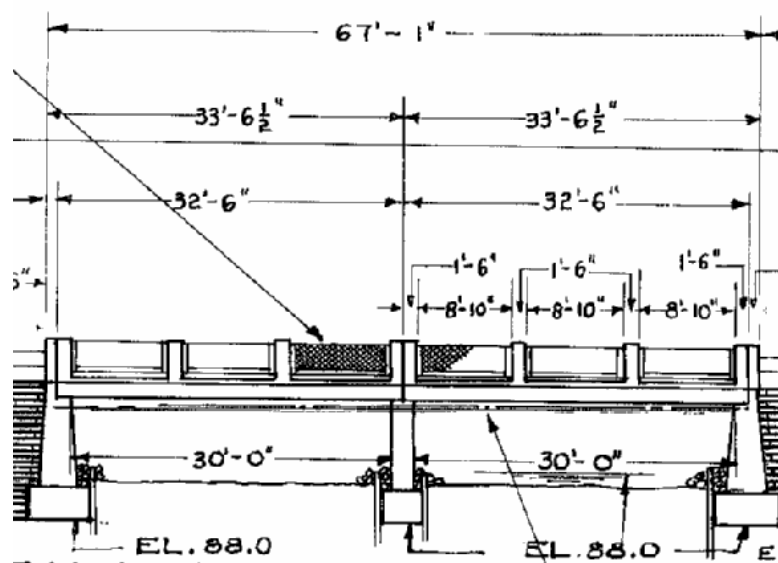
Vue en élévation de l'ouvrage (Vue amont – plans d'origine [5])
